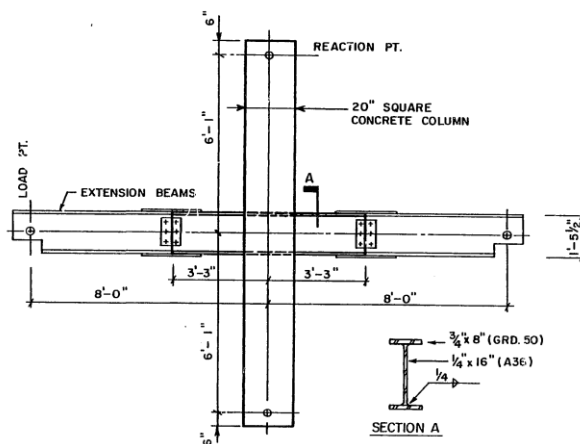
Pruebas de las muestras desde la #3 hasta la #9. Nota: Shikh muhammad t. moment connections between steel beams and concrete columns (1987) (pág.41)
